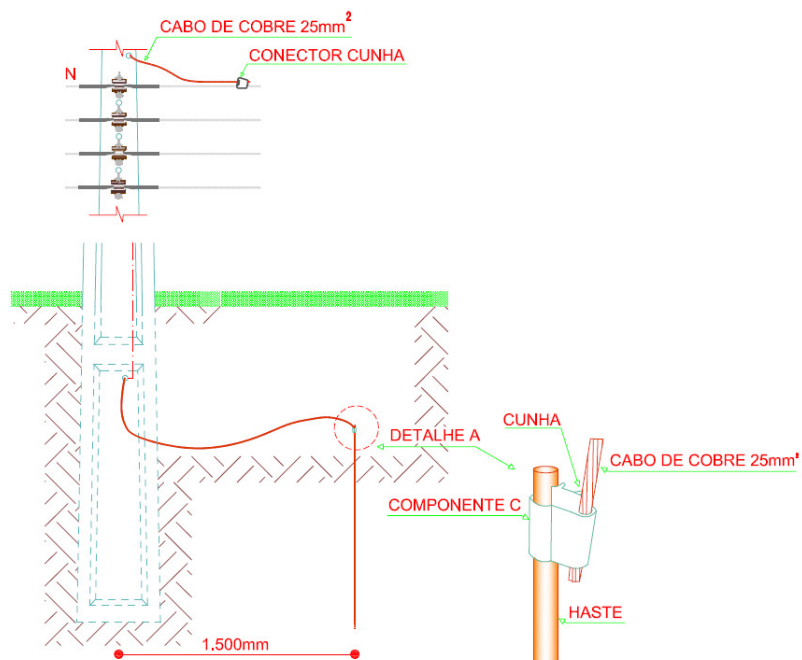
Aterramento de Rede Secundária em Estrutura em Alinhamento
